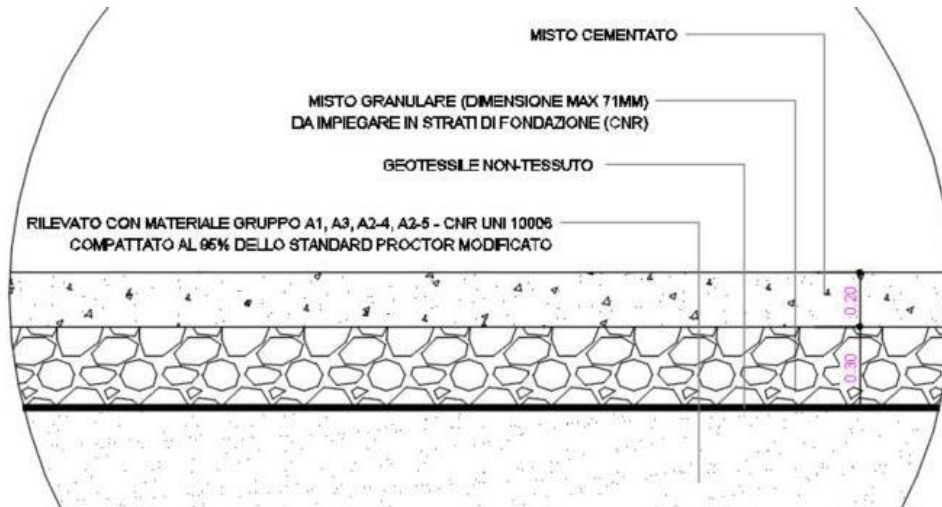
Pacchetto pavimentazione in misto cementato
